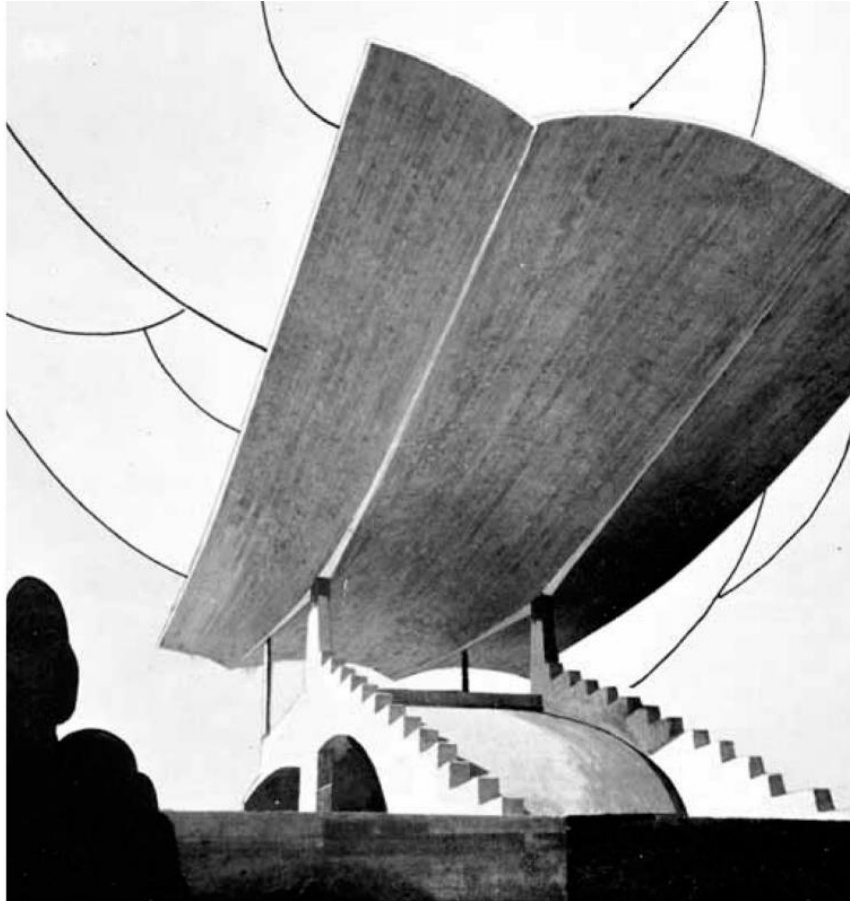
Módulo estructural de las tribunas. (Fuente: Revista Ingeniería y Territorio, nº 79, 2007)
